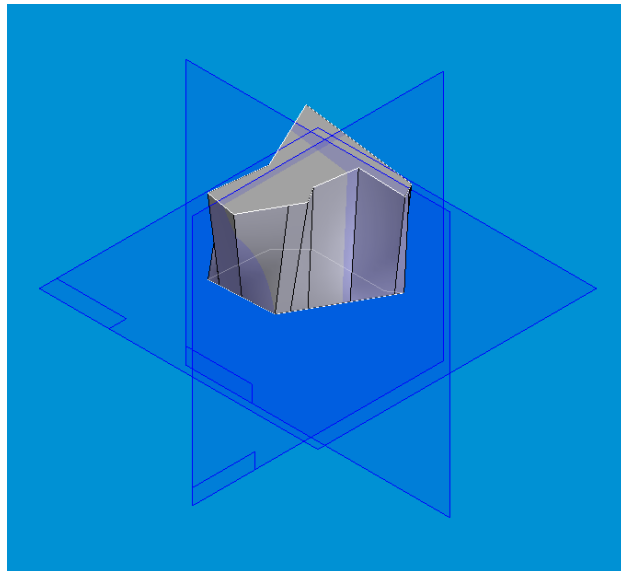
Ricostruzione geometrica del pilastro 28.
